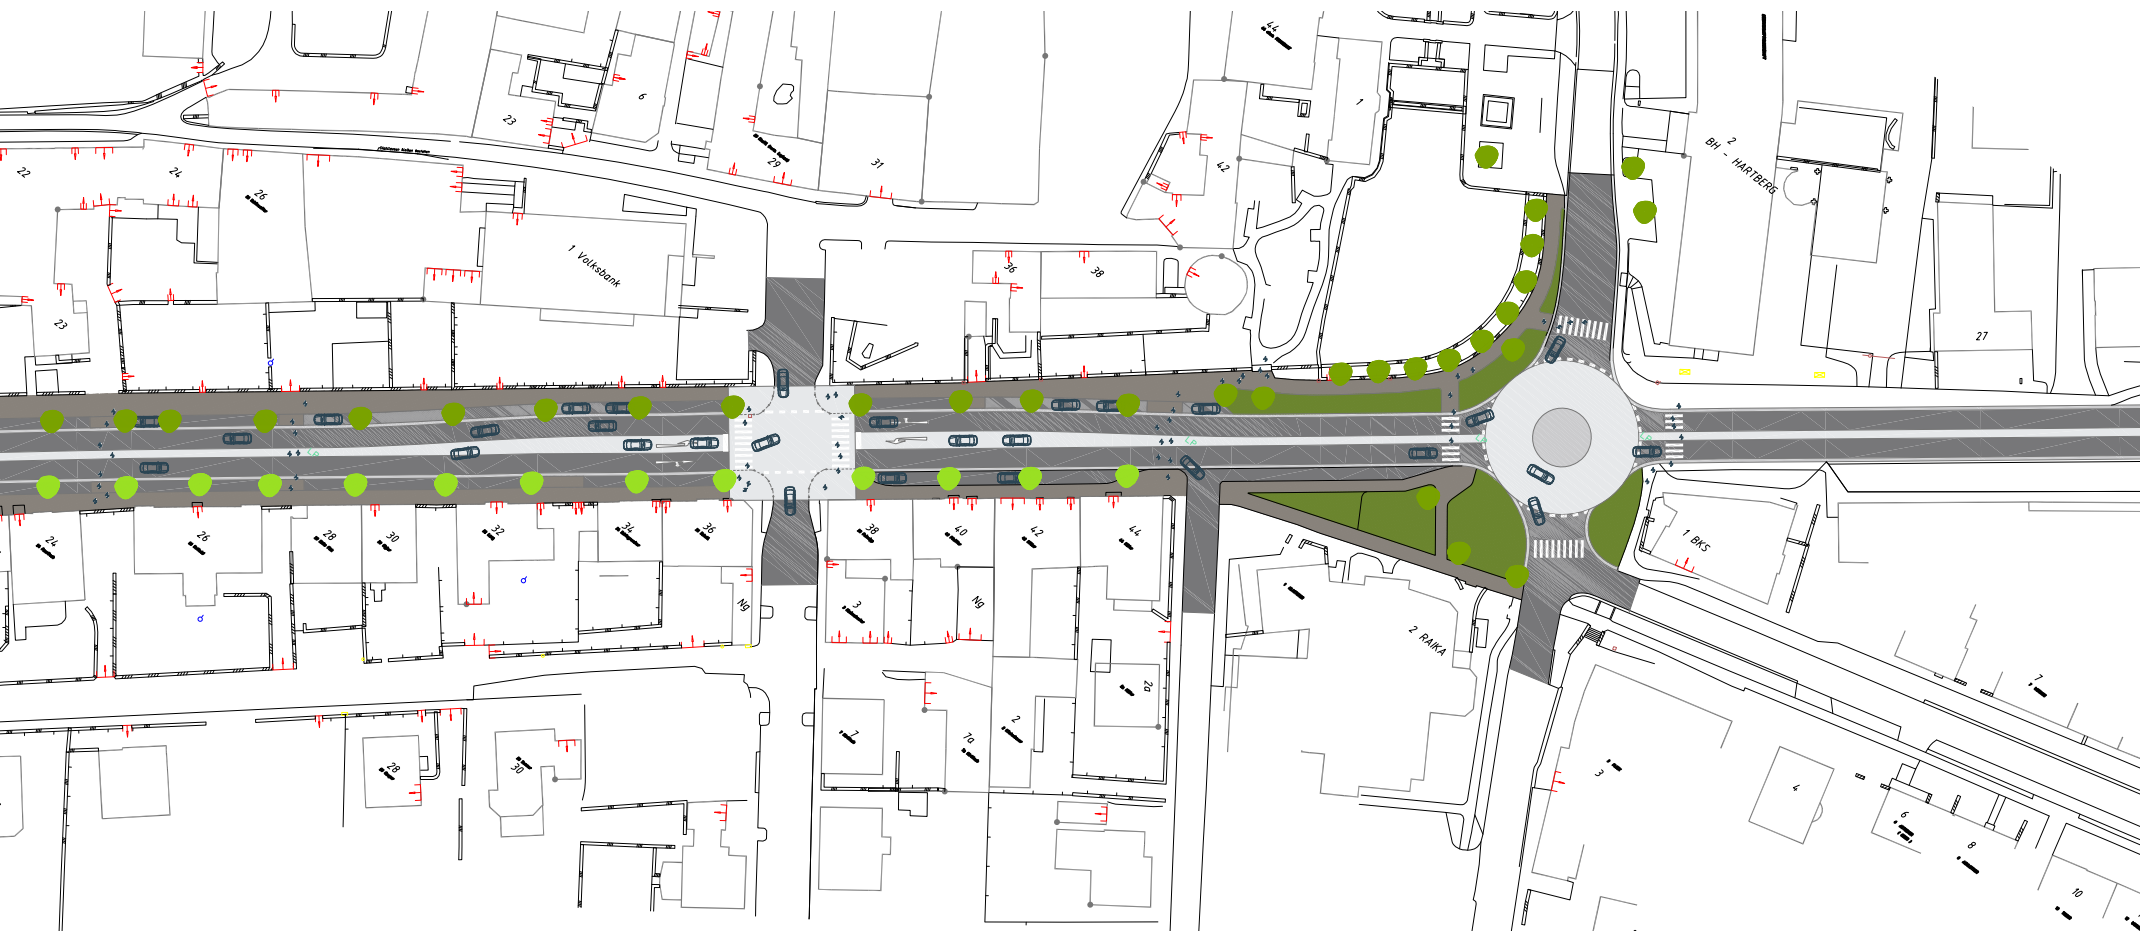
Entwurfsgrundriss Übersichtsplan Rössvarstraße
